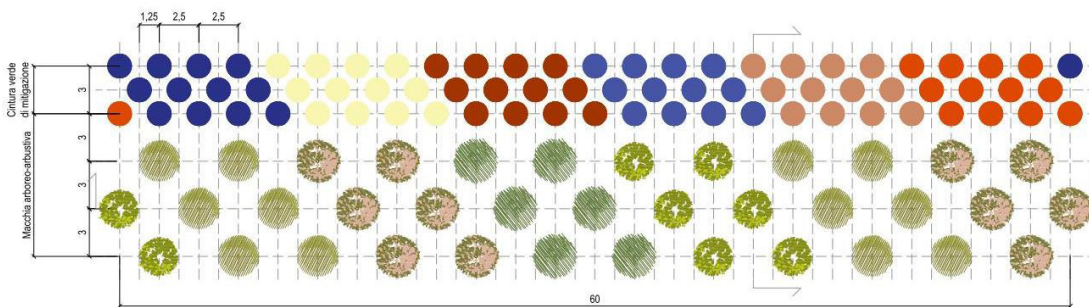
Sesto d'impianto e sezione tipologica
